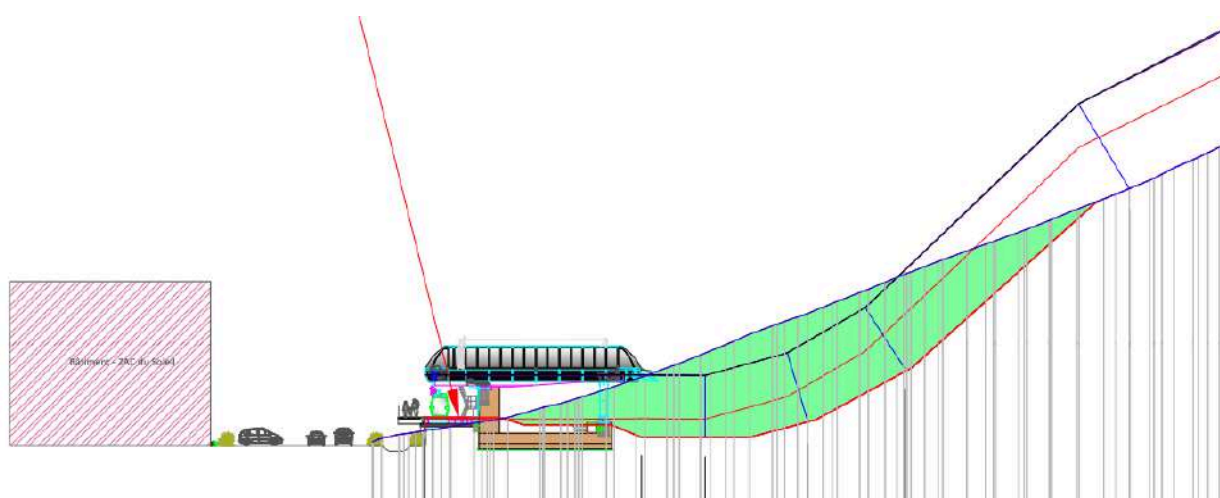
Détail du profil en long au niveau de la gare G1 - ERIC
